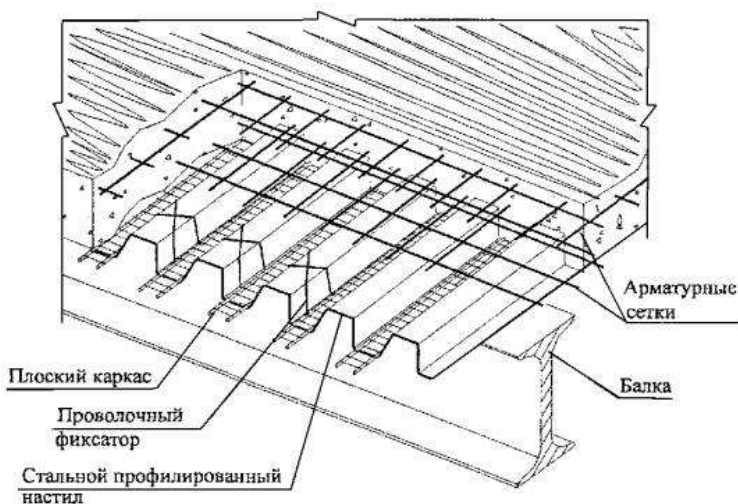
Перекрытие из монолитного железобетона по профилированному настилу
